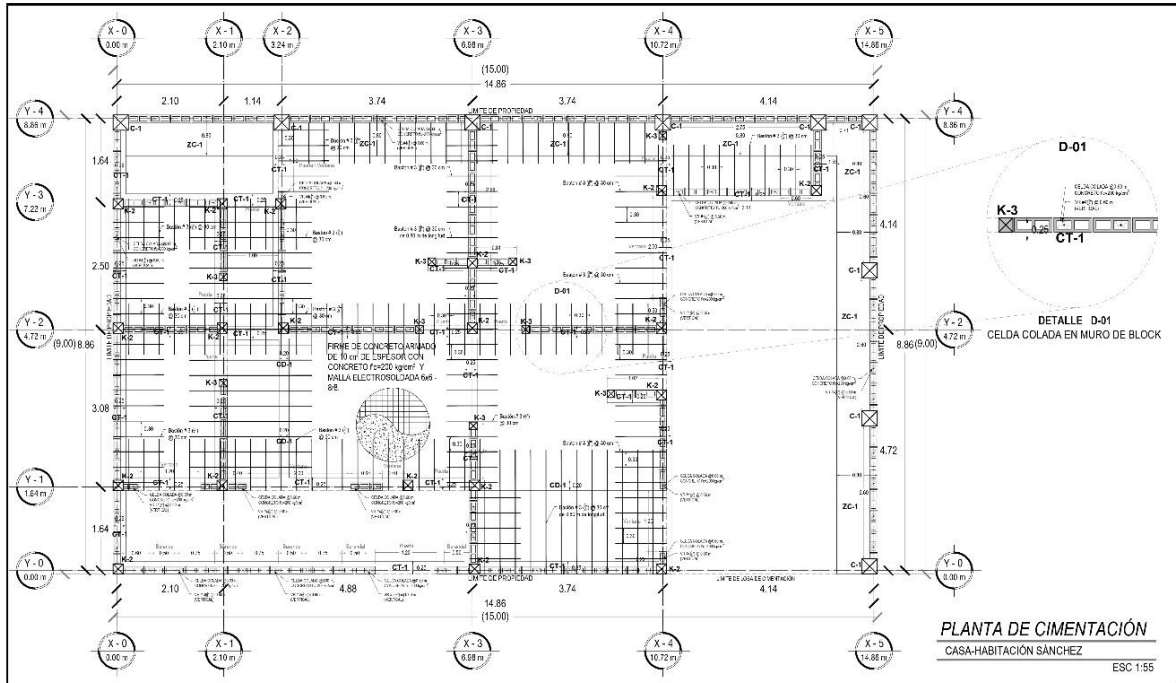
Planta de cimentación (elaboración propia) (véase en anexos).
